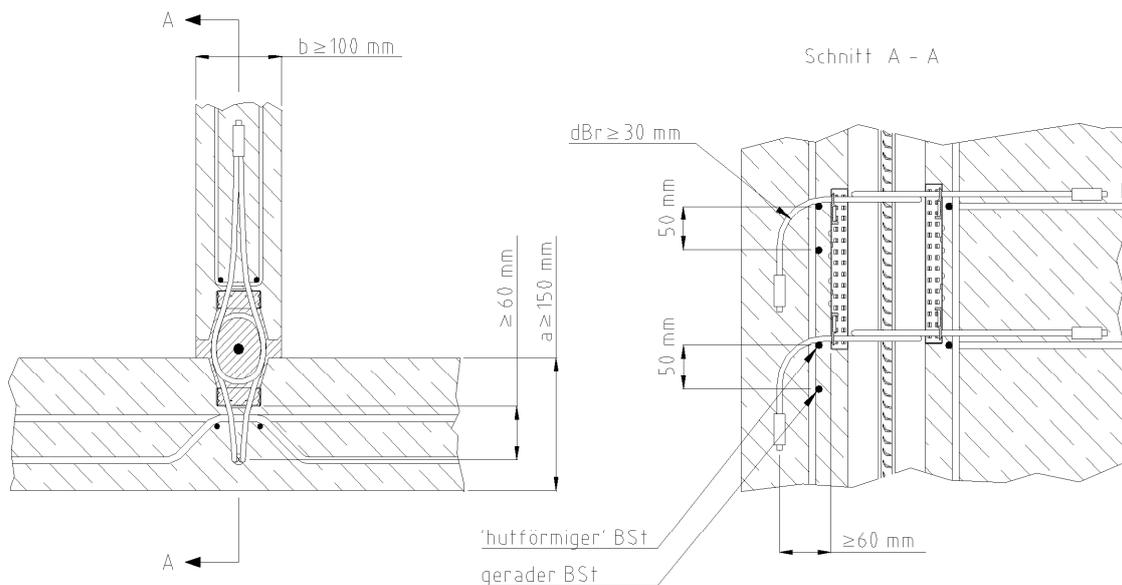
Wand – Wand – T-Verbindung - Detail mit abgewinkelten Seilschlaufen
